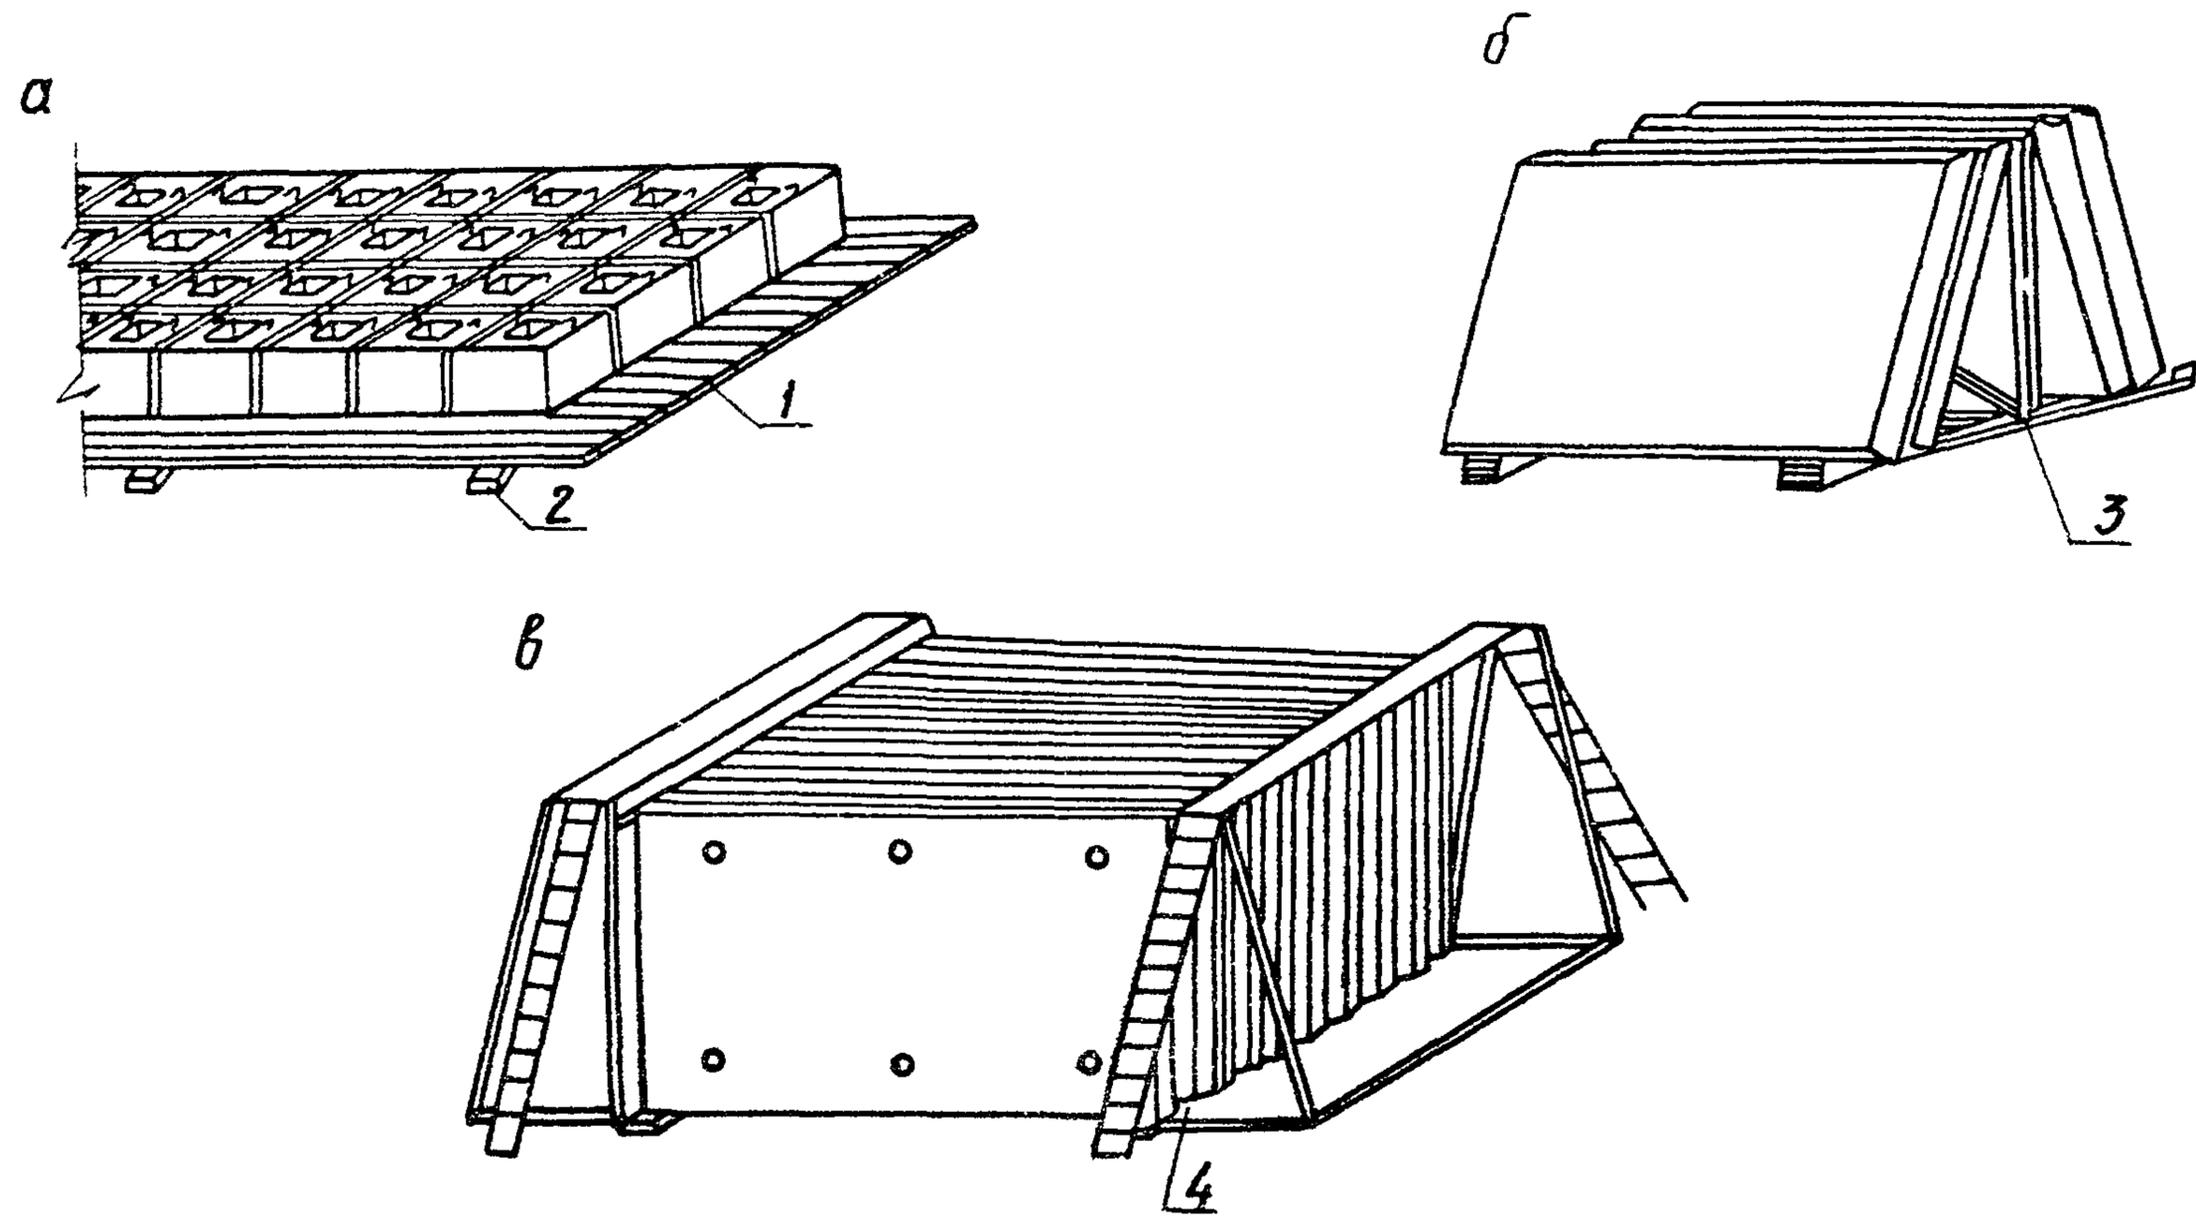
Складирование сборных конструкций: а-оголовков; б-покольных панелей; в-панелей перекрытий; 1-настил из досок 40 мм; 2-подкладка 80x80 мм; 3-металлическая пирамида на 4 покольные панели; 4-кассета конструкции Гипрооргсельстроя
